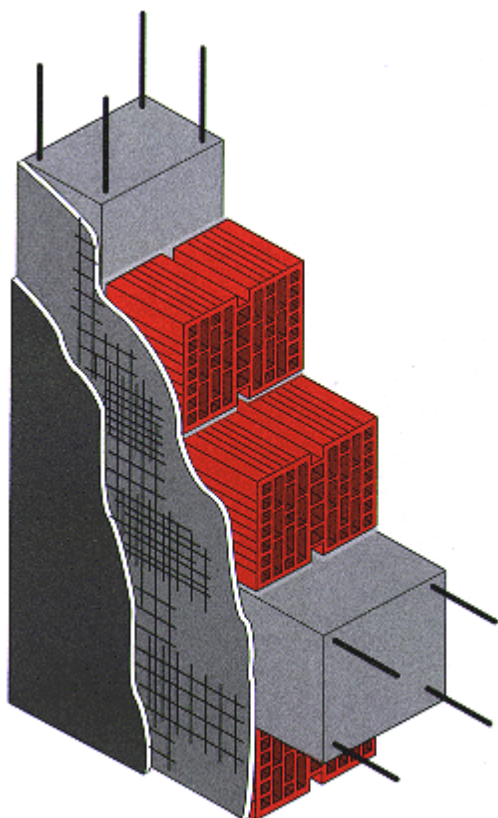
Protezione dei punti di collegamento fra struttura in cemento armato e muratura di tamponamento.
